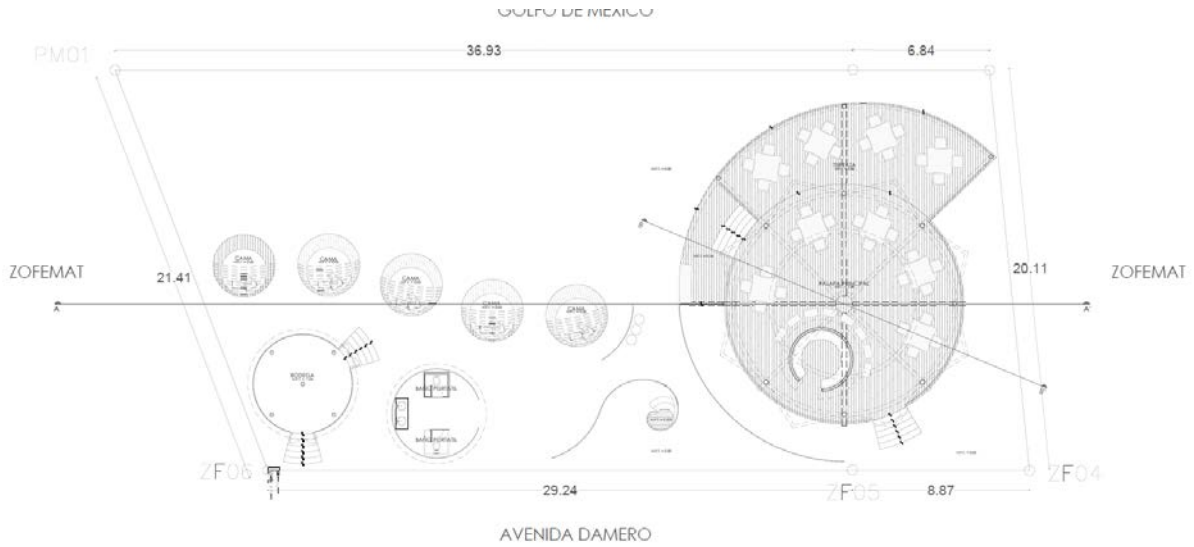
Plano planta baja del Proyecto Beach Club Makachi
